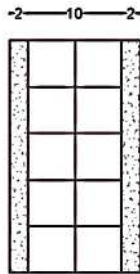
coupe transversale du mur en simple cloison (10cm).
